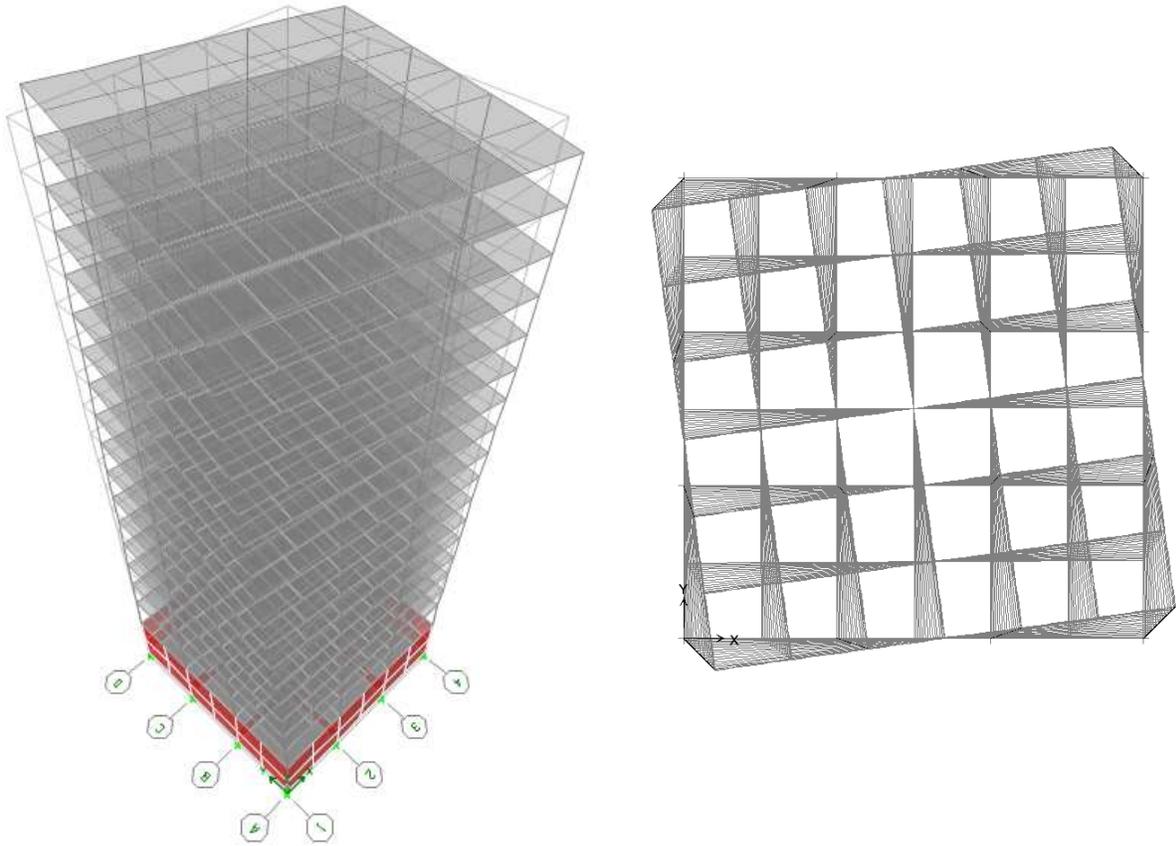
Vista en elevación y planta de la deformada del tercer modo de vibrar del edificio de 17 niveles
